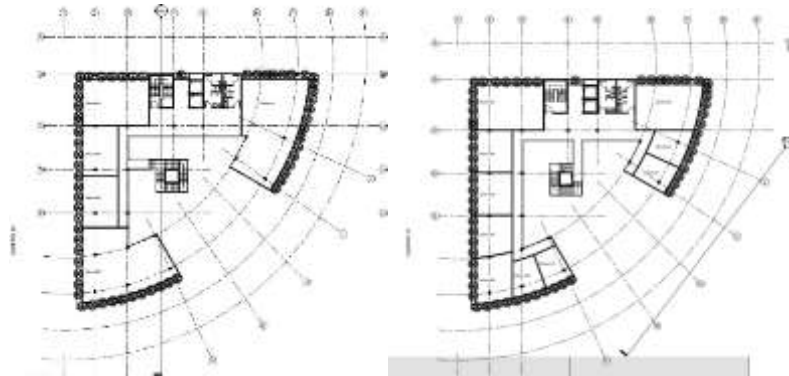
Plantas Tipo Oficinas Nivel 3-7 Esc 1:200
